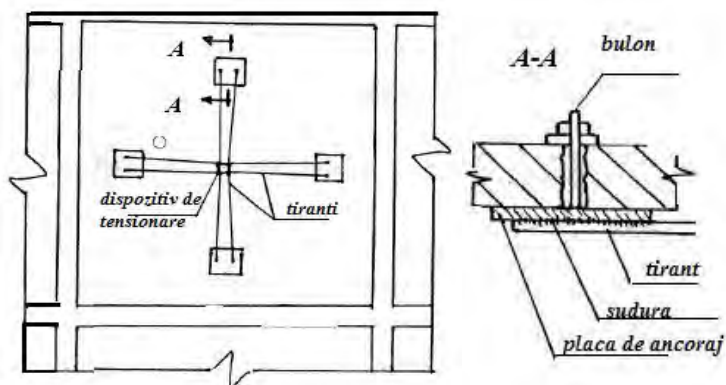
Consolidarea plăcilor prefabricate din beton armat cu tiranți metalici [76]
